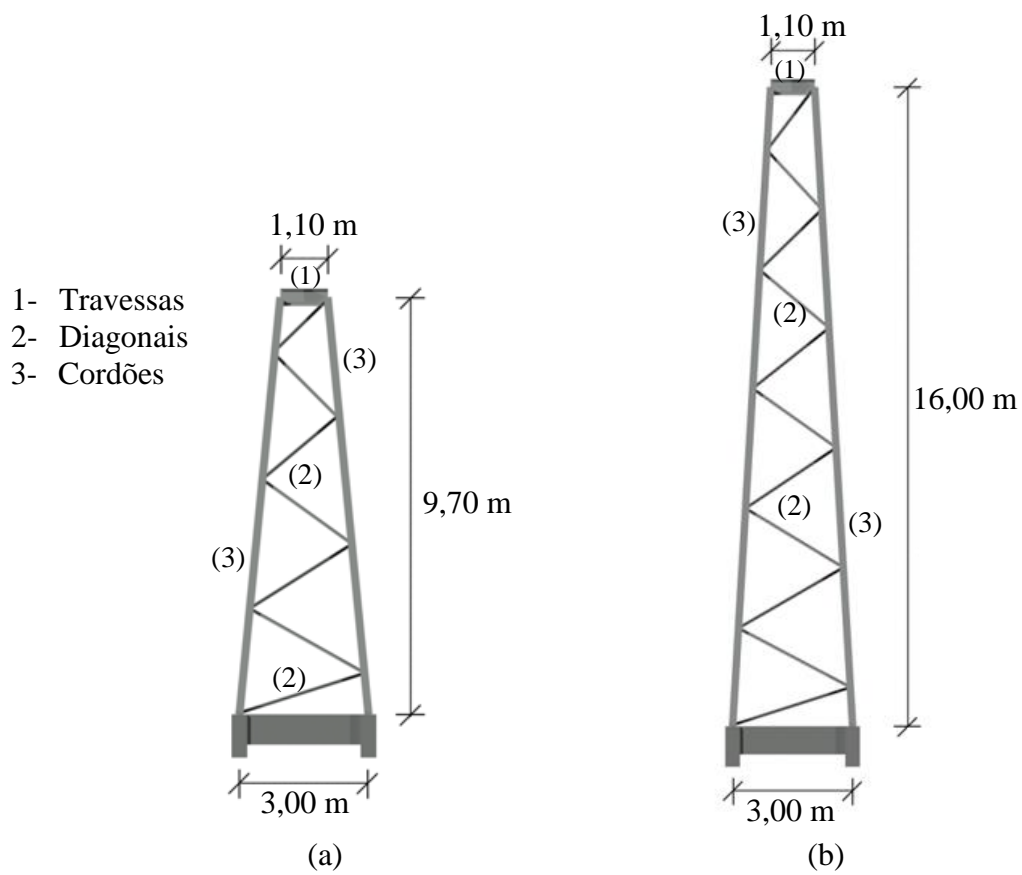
Pilares: (a) Pilar P2; (b) Pilar P3, P4, P5 e P6
